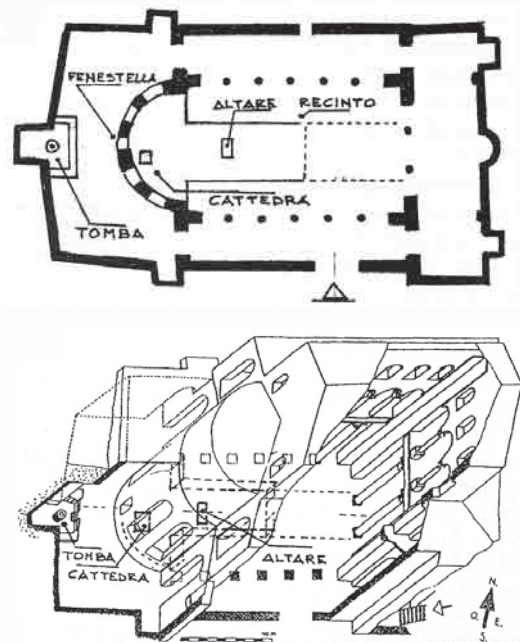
Planta y axonometría de la basílica menor de San Lorenzo Extramuros (a partir de BOTELLA-SÁNCHEZ, 2008).
